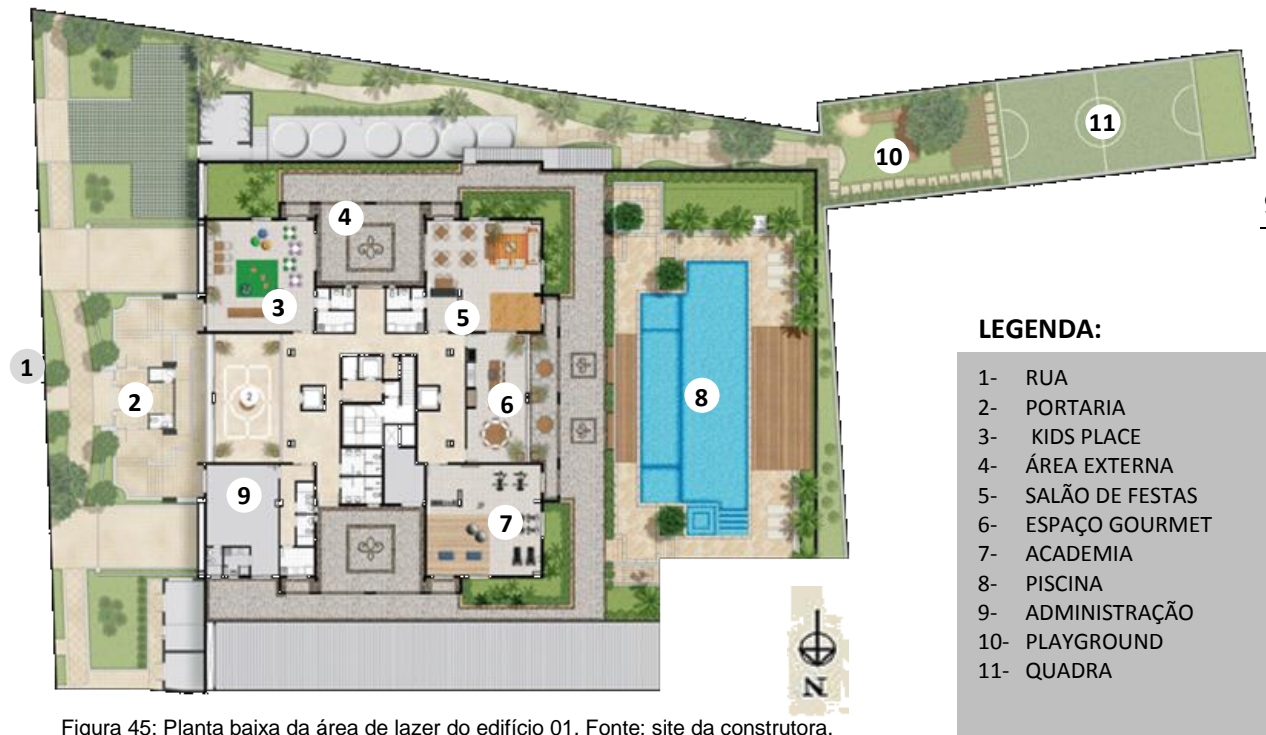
Planta baixa da área de lazer do edifício 01. Fonte: site da construtora.
